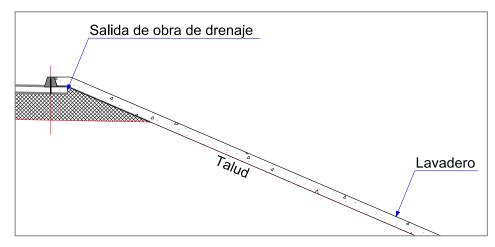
Ubicación de lavadero a la salida de las obras de drenaje transversal, Detalle, 2017
